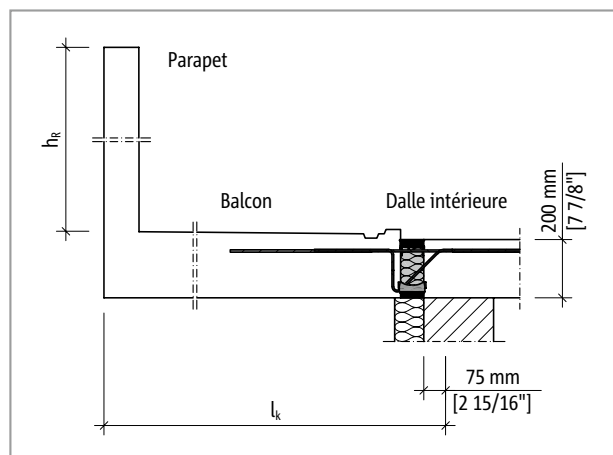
Schöck Isokorb® T Type CK : Système statique
